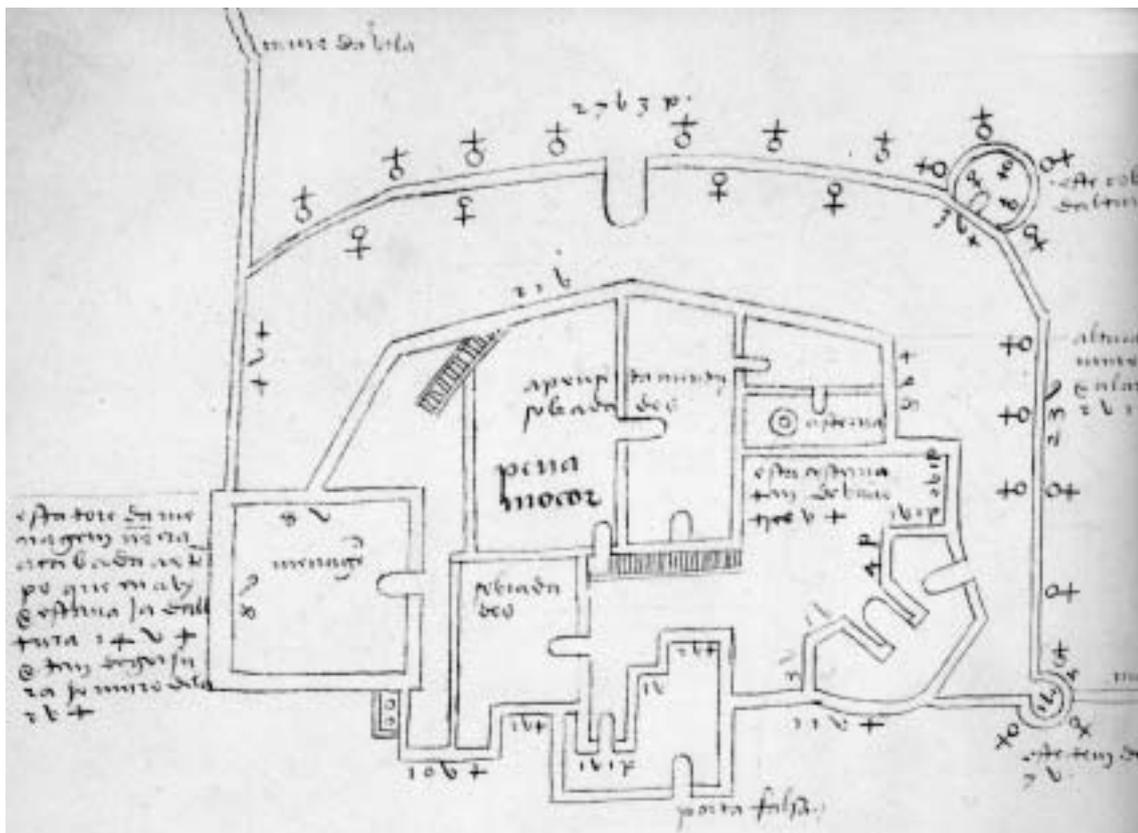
Planta do castelo de Penamacor (segundo Duarte de Armas).
